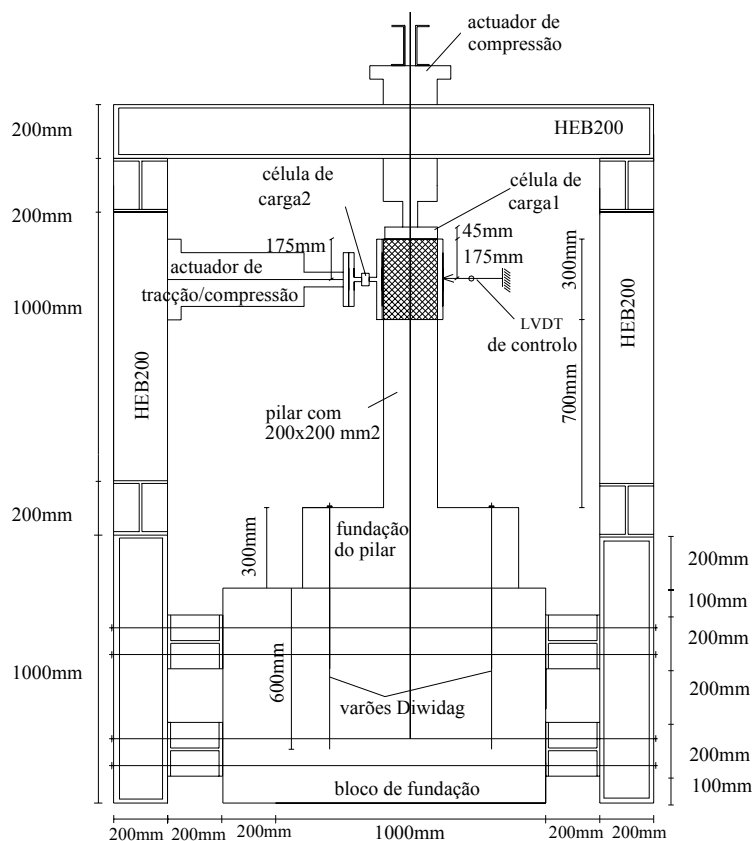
a) – Esquema do sistema de ensaio: vista em planta.
